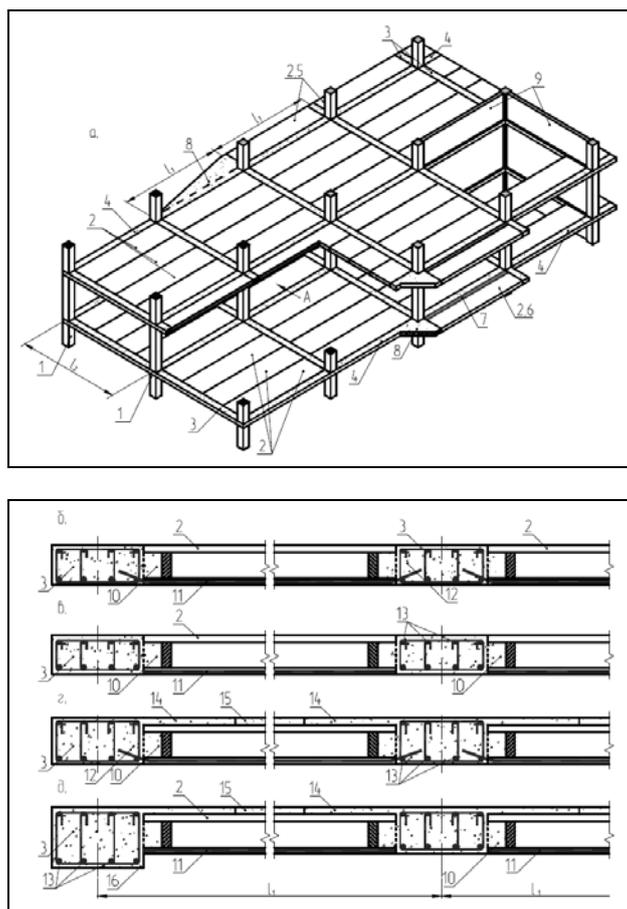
Конструкция каркаса и варианты поперечных сечений монолитных несущих ригелей
